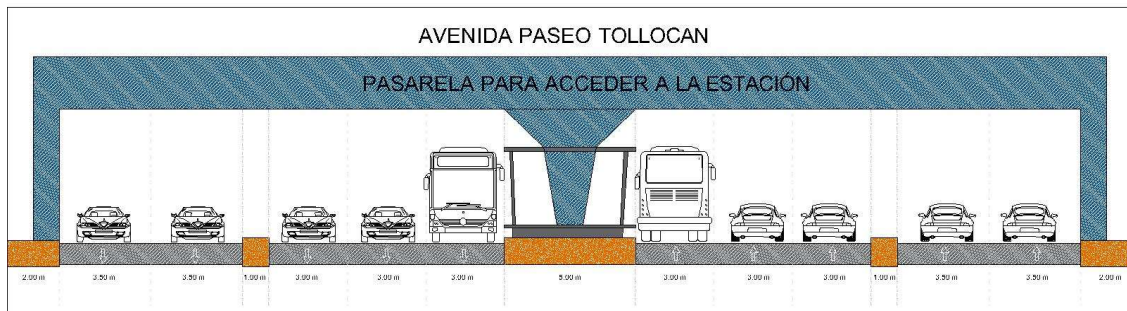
Sección en camellón central con pasarela (Elaboración propia).
